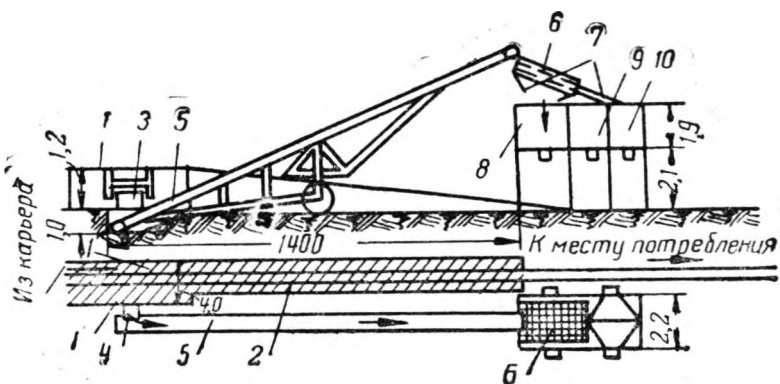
Схема установки для дробления камня и сортировки щебня производительностью 12—15 т/час
